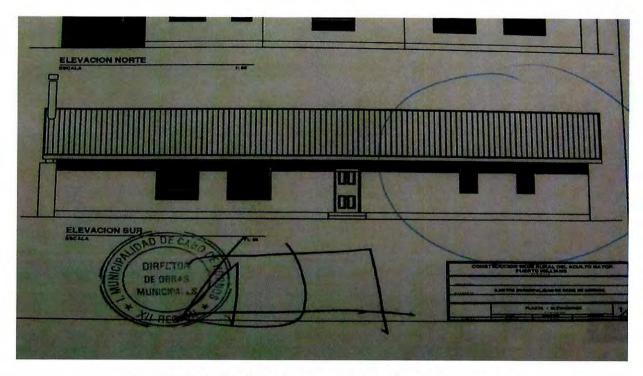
Fachada lado sur proyectada con 4 ventanas.
